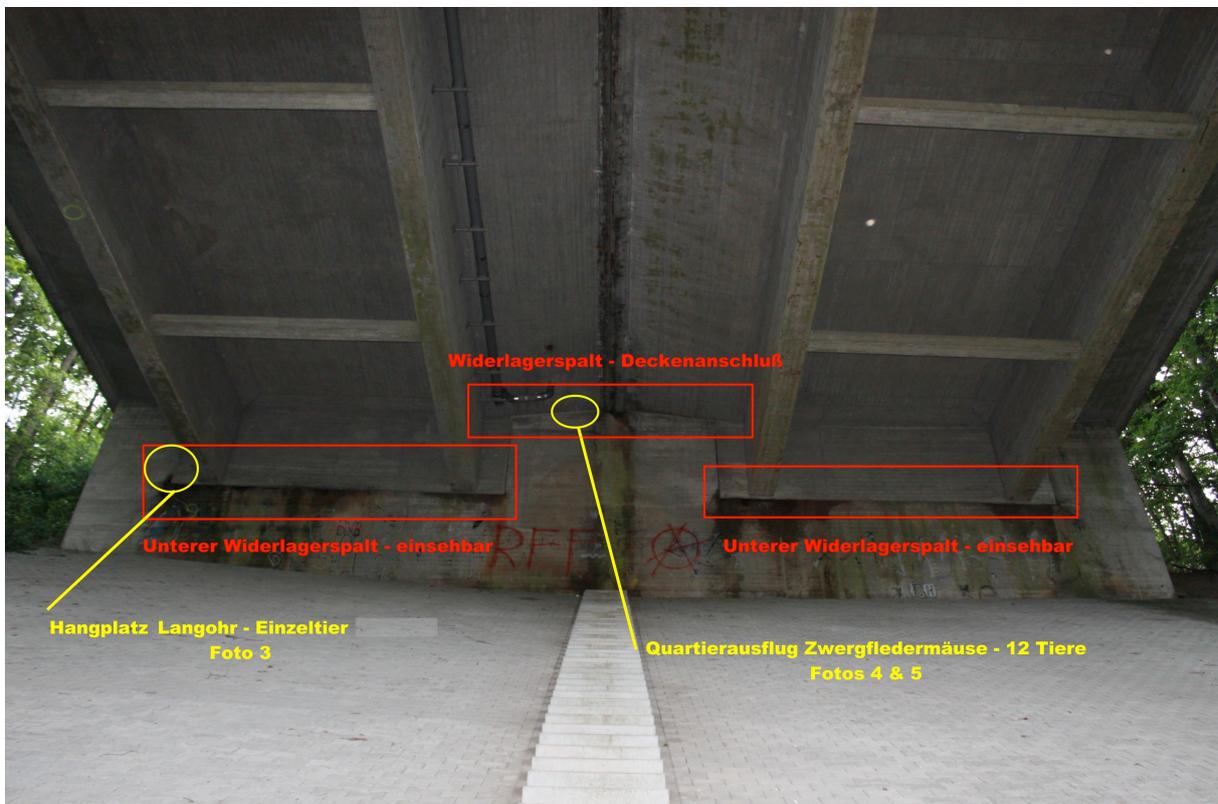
Westliches Widerlager mit dem einsehbaren Widerlagerspalt und dem nicht einsehbaren Widerlagerspalt am Deckenanschluß sowie die Position der Fotoaufnahmen 3 und 4.
